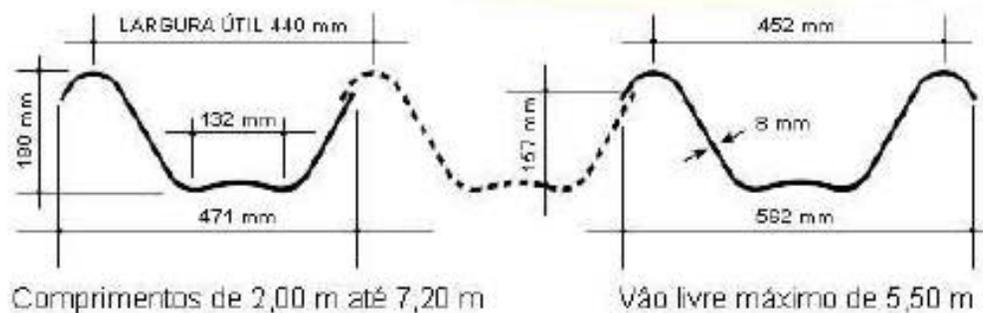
Telha autoportante de fibrocimento – modelo “Canalete 44”.
